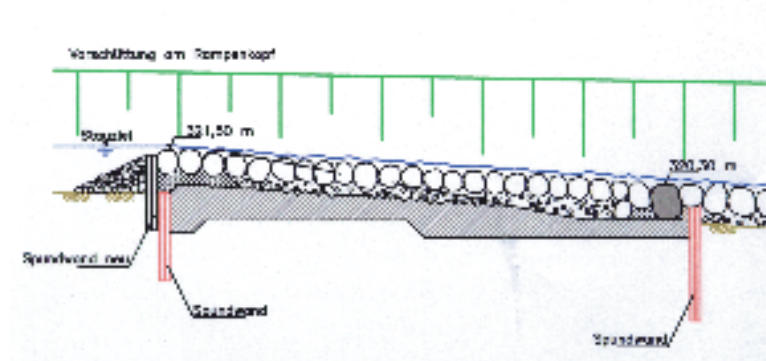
Anbindung einer großen Sohlenrampe an ein teilabgebrochenes Querbauwerk. Zur Stabilisierung des Rampenkopfes wurden die Deckwerkssteine in Beton versetzt. Dies garantiert bei großen hydraulischen Belastungen genügend Stabilität und verhindert so ein lokales Versagen des Bauwerkes. Ebenfalls deutlich zu erkennen ist die kleine Anrampung vom Rampenkopf hin zum Oberwasser. Dadurch wird die Sohle durchgängig angeschlossen. Um die Durchsickerung des Rampendeckwerkes möglichst gering zu halten, wurde die bestehende Spundwand am Rampenkopf erhöht.
